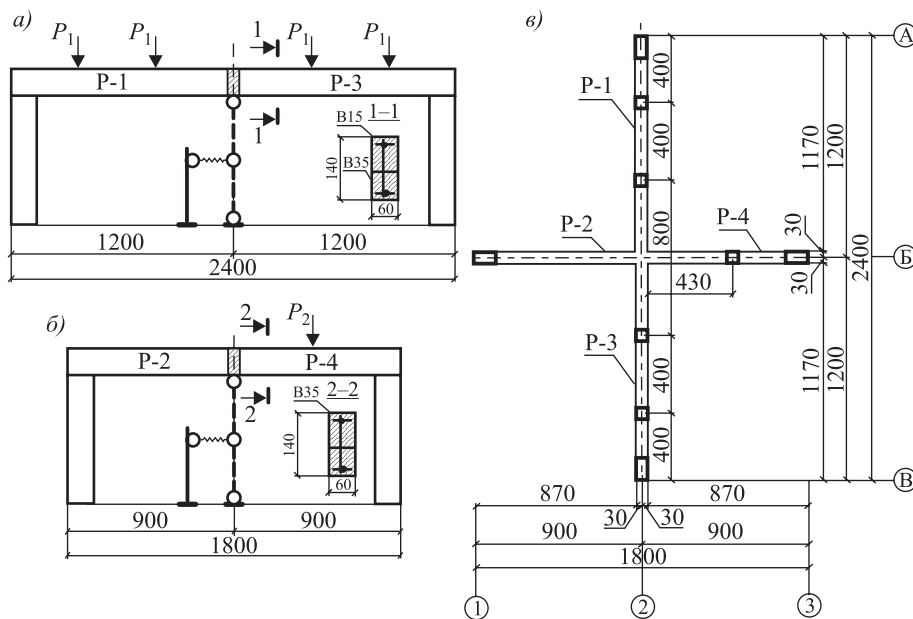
Схема конструкции фрагмента железобетонной рамы по оси А-В (а); по оси 1-3 (б) и в плане (в)
